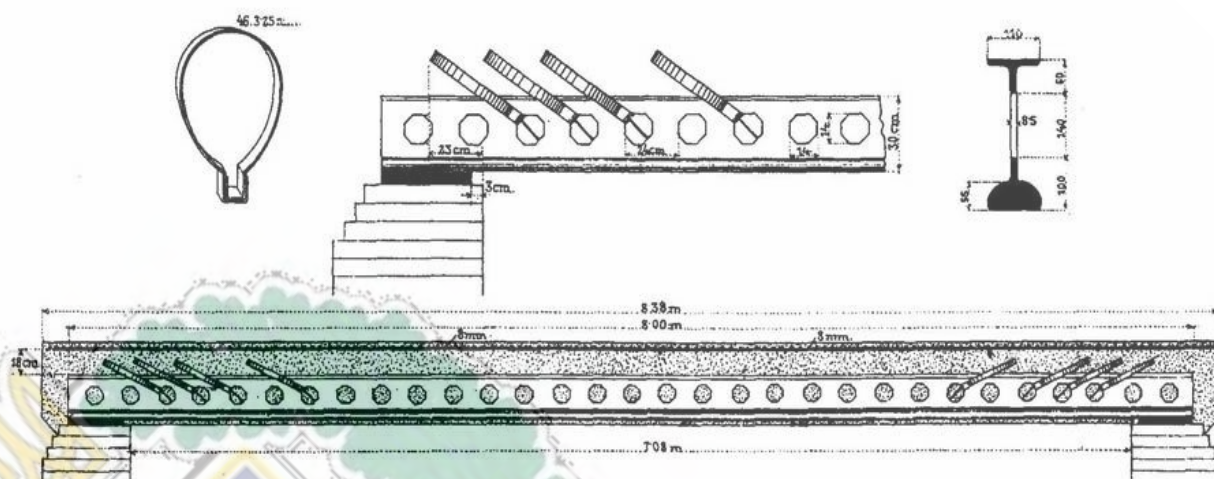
Схема армування перекриттів за розробками Ф. Похлмана (1901)
